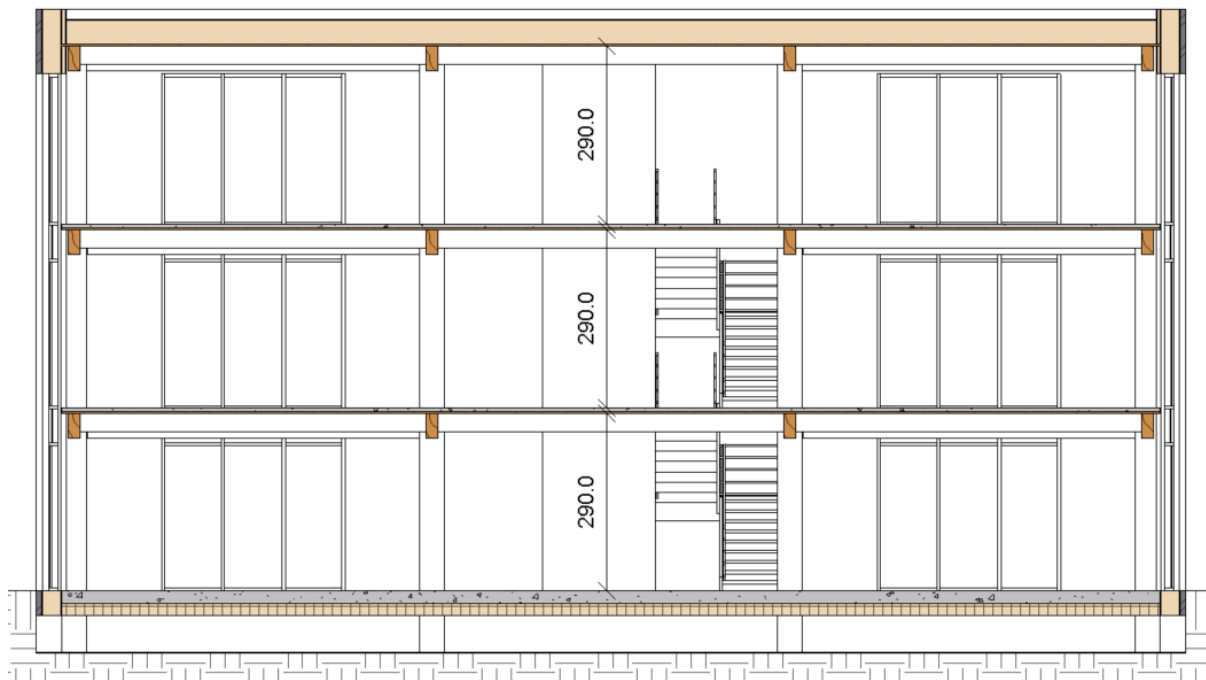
Coupe NC2 – Reconstruction ossature bois passive +
